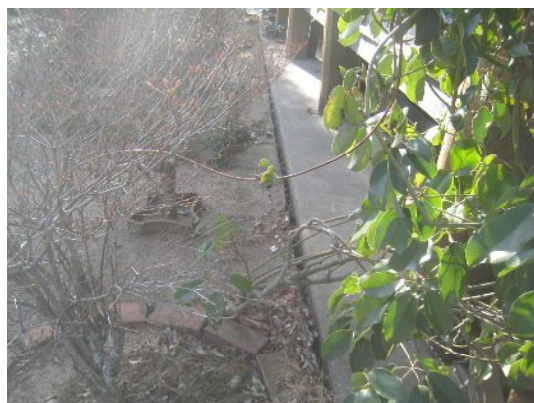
コンクリートスラブ周辺の間隙と木柱のズレ・傾斜。
